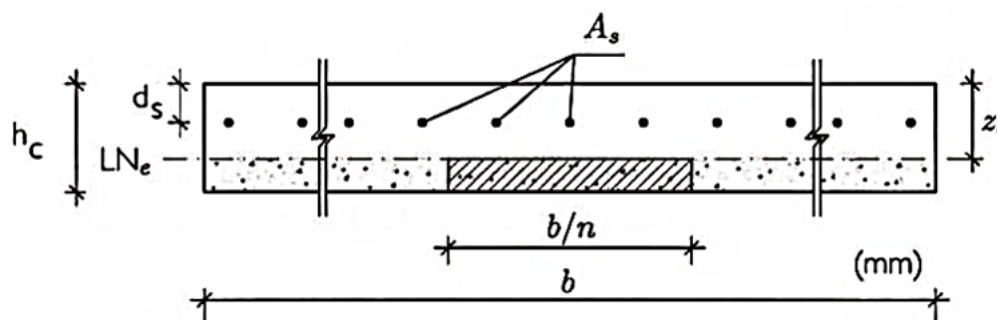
Geometria de secção para o cálculo da inércia I_2 em flexão negativa para laje maciça (adaptado de Calado e Santos, 2010).
